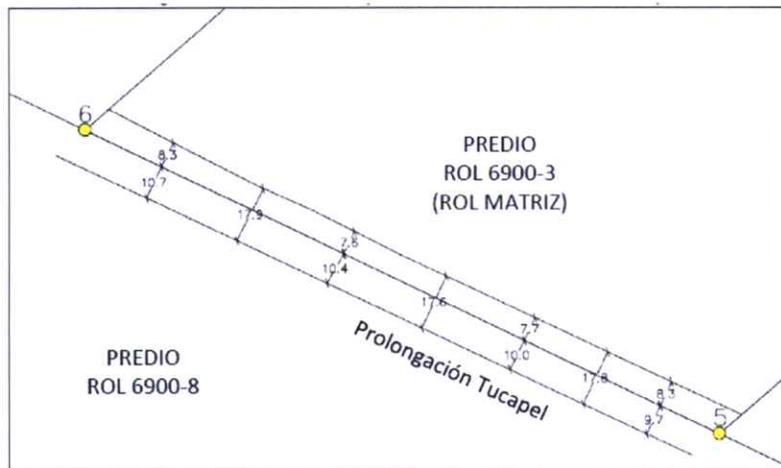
, Plano de Vialidad 15° Modificación PRC Concepción, Escala 1:15.000
